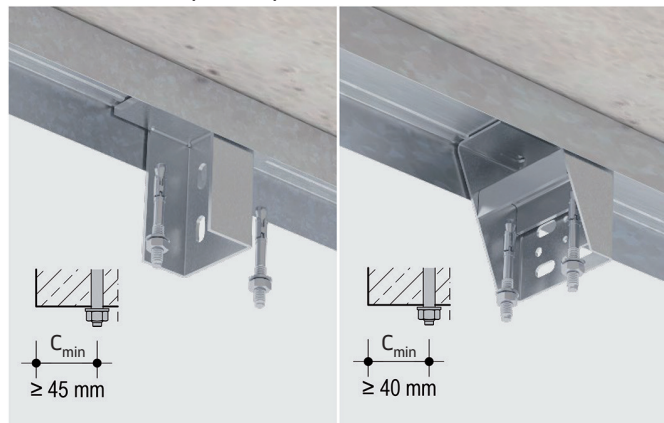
Montage oberes UW-Profil, Festlegung erster Teilabschnitt Deckenschürze
